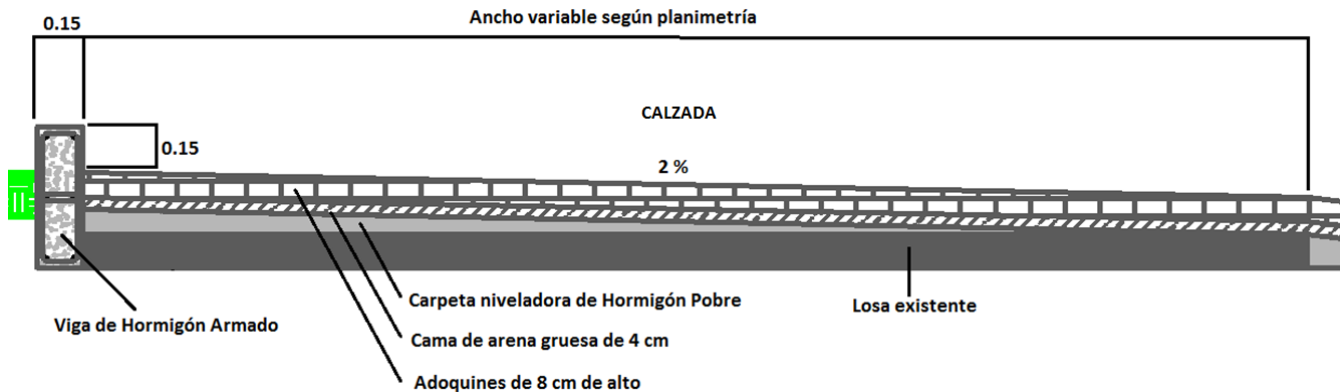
Detalle de tramo principal de calzada y viga de confinamiento
